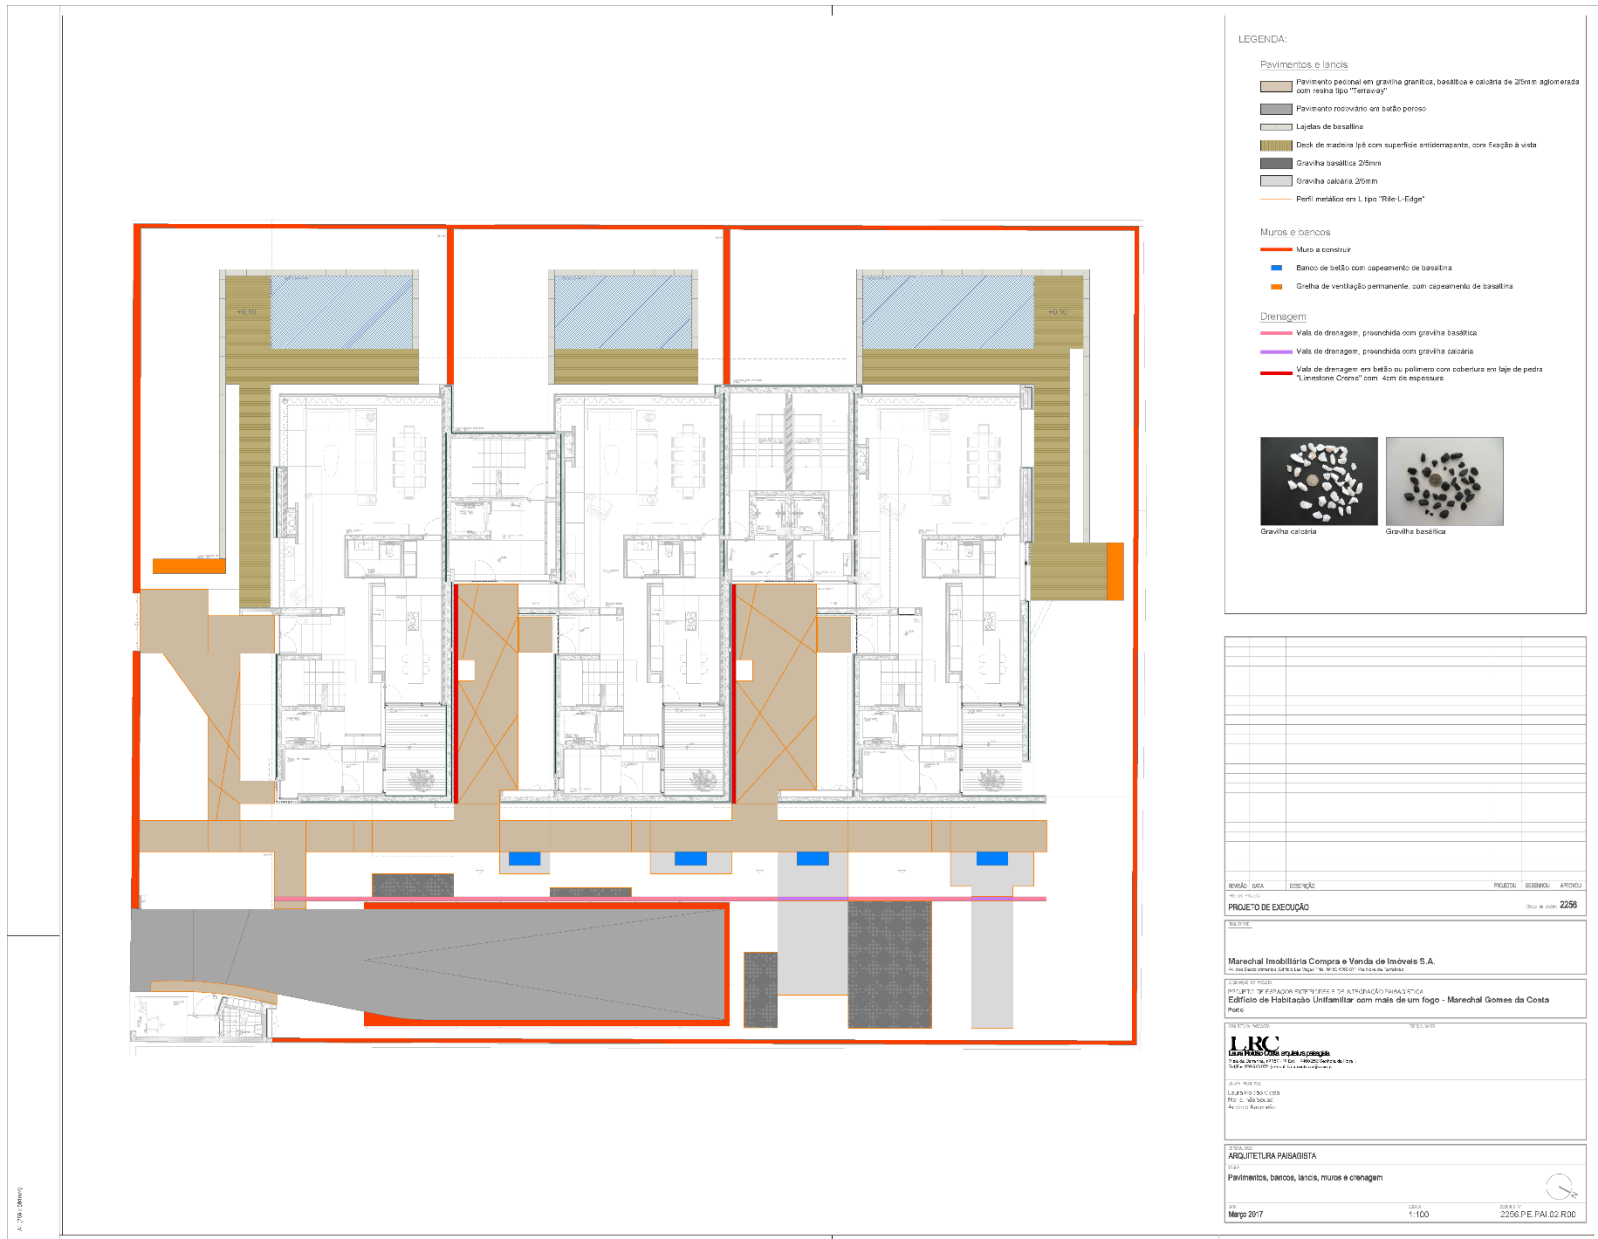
Plano de pavimentos, bancos, lancis, muros e drenagem do Projeto Marechal 1000.
